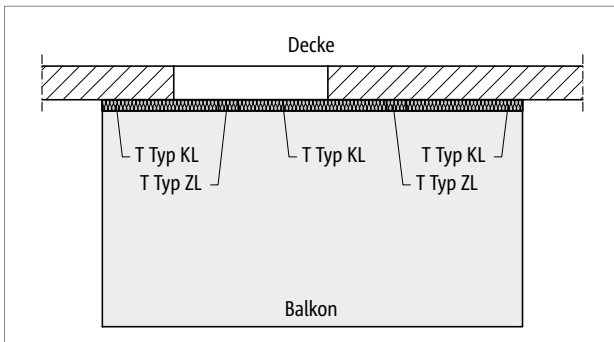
Schöck Isokorb® T Typ ZL, KL: Balkon frei auskragend
